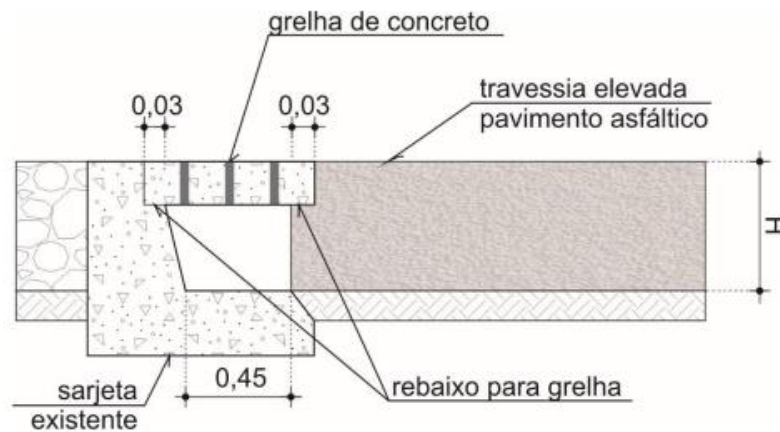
Corte A-A - projeto tipo da travessia elevada de pedestres
